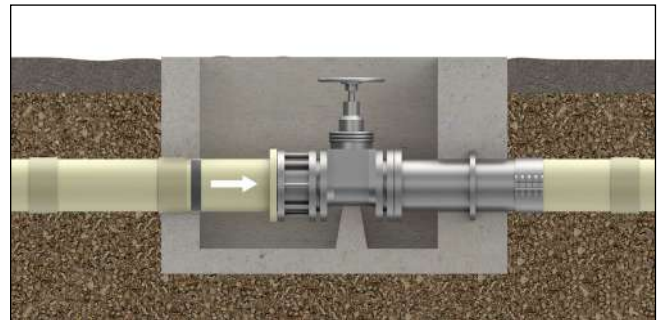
Tipo 4 – Ancoragem com flange de fundo de aço
